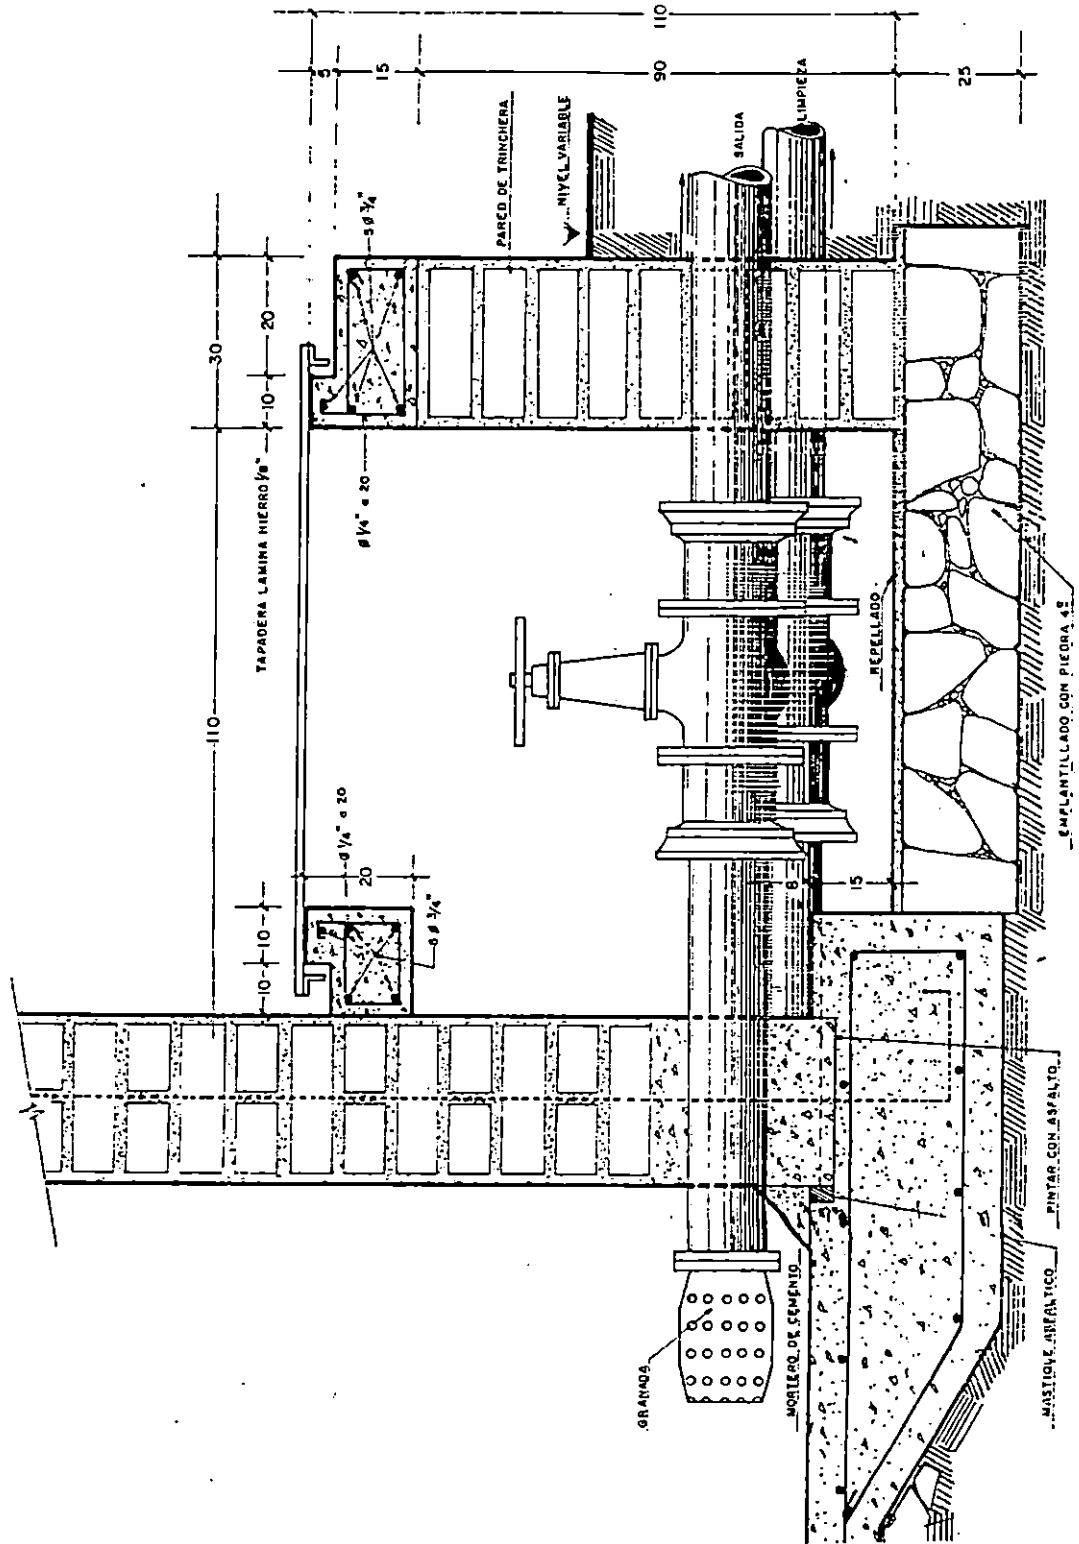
(B) Detalles Constructivos de Tuberías de entrada , salida y de limpieza; y de la Caja de Válvulas.
